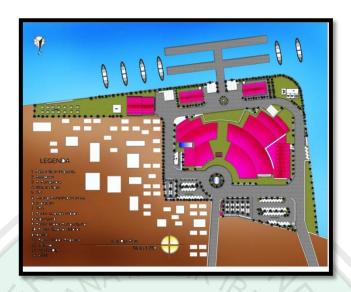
Denah Penyimpanan Garam Dan es Balok
